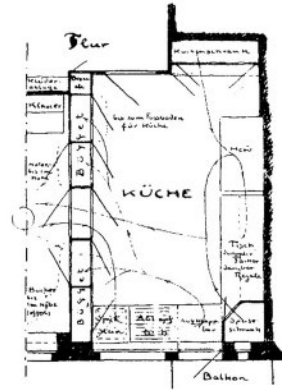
Bruno Taut: Grundriss einer verbesserten Wohnung. Leipzig 1924
